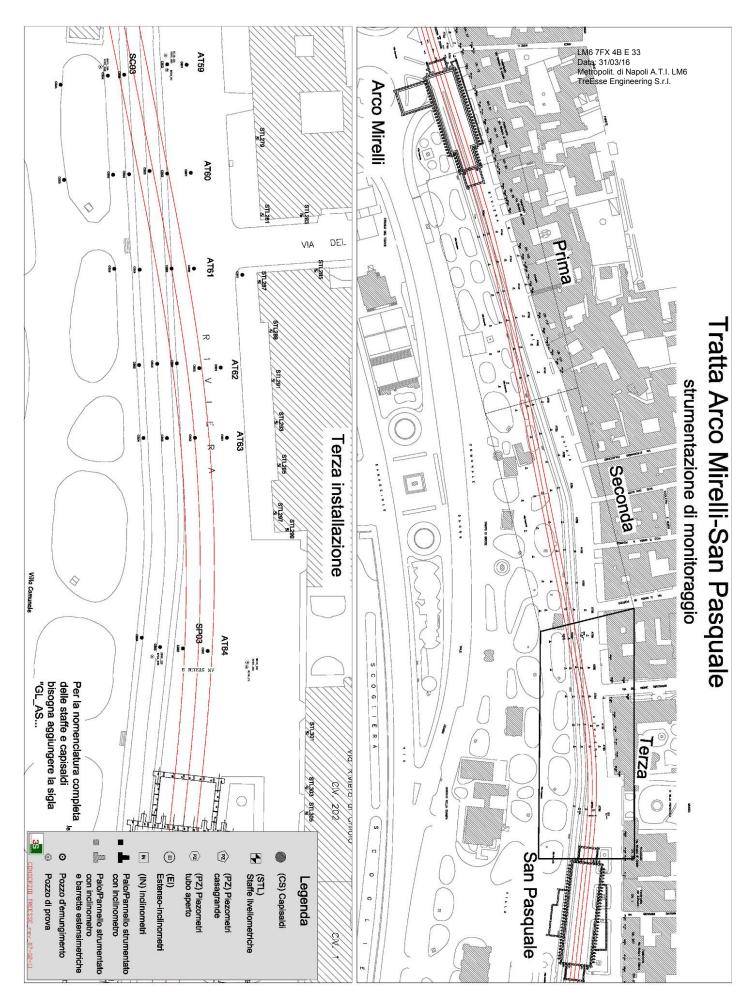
Planimetria tratta Arco Mirelli-SanPasquale, raffigurante la disposizione della terza installazione della strumentazione di monitoraggio
